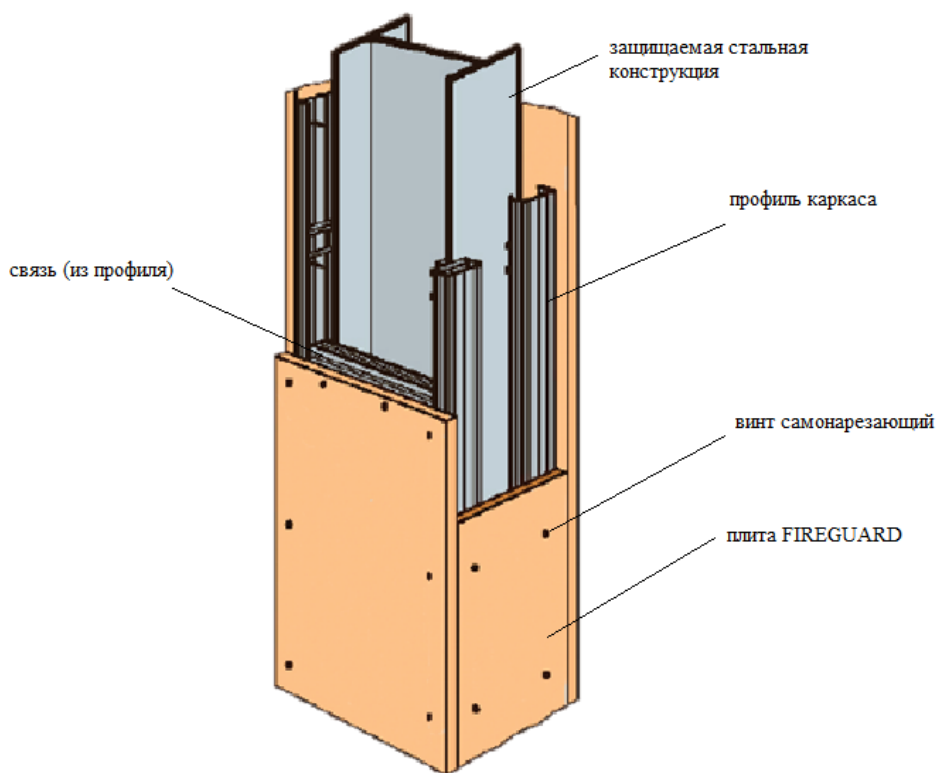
Устройство плитной конструктивной огнезащиты на стальных конструкциях
